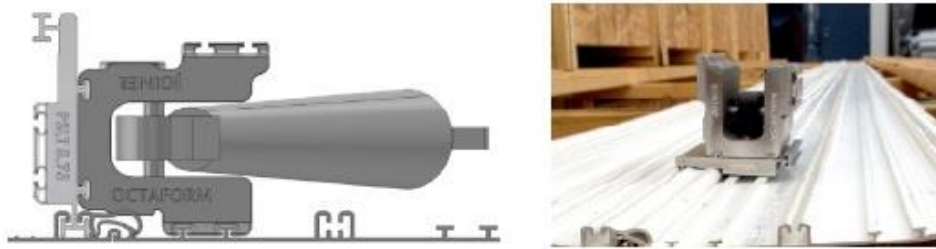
Encaixe final com a *Zip Tool* dos painéis SLT
